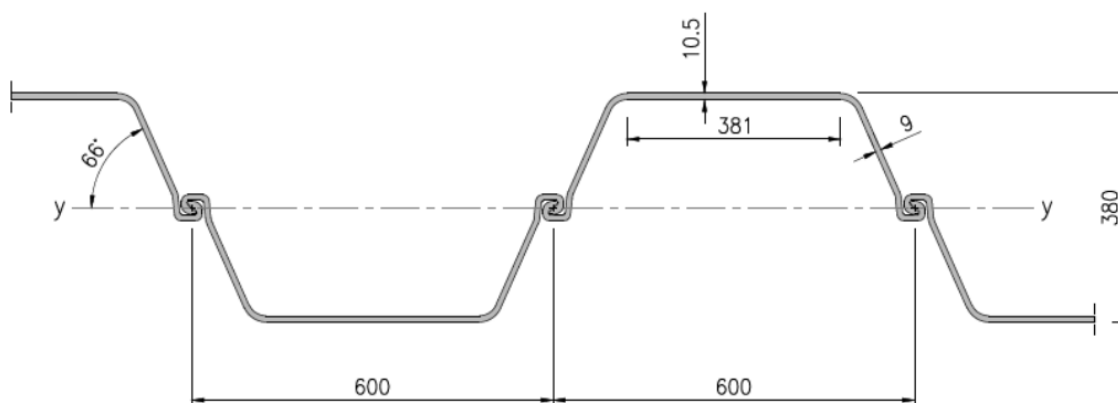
Palancole con sezione a U tipo Larssen 604
